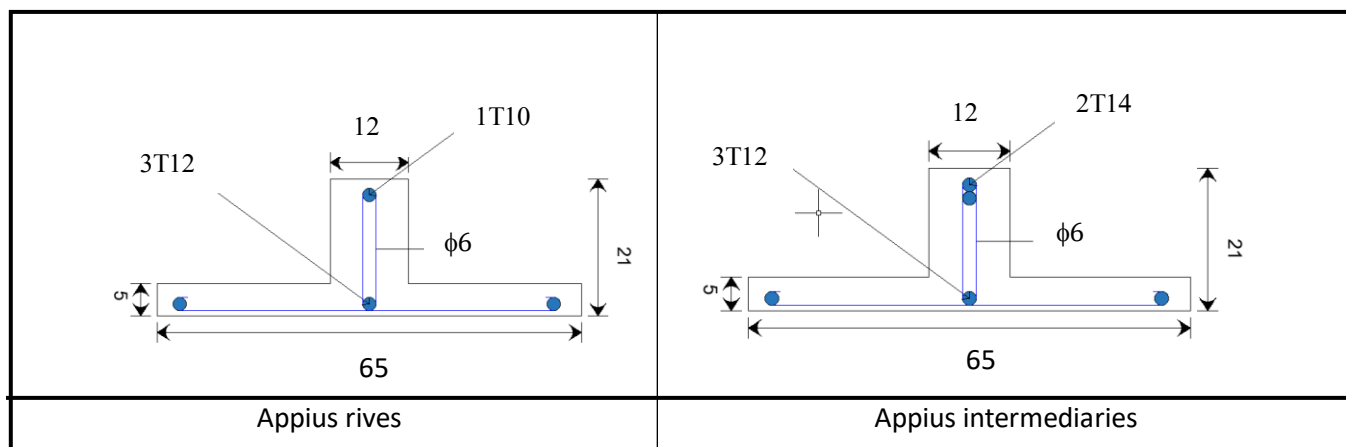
dessin de ferrailage des poutrelles de terrasse
